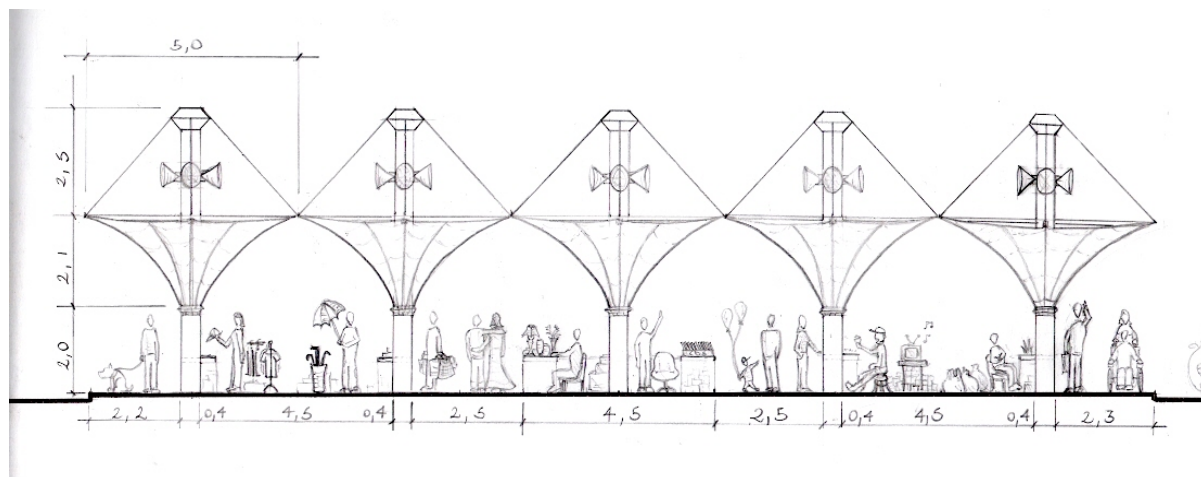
“Proposta dos alunos para a praça que abriga feiras de artesanato e de alimentação”
